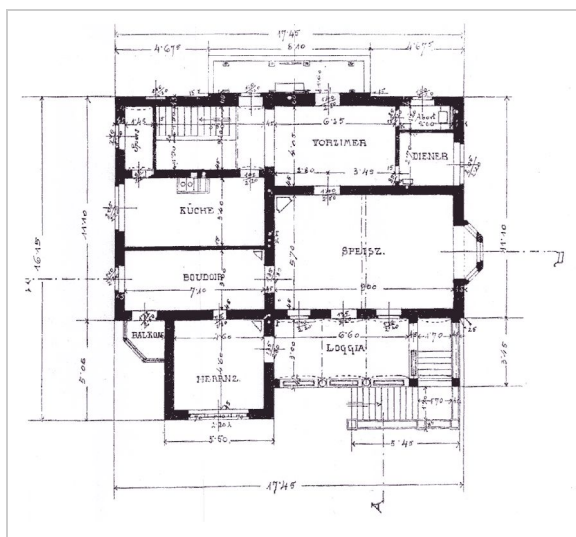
Grundriss des Erdgeschoßes.
